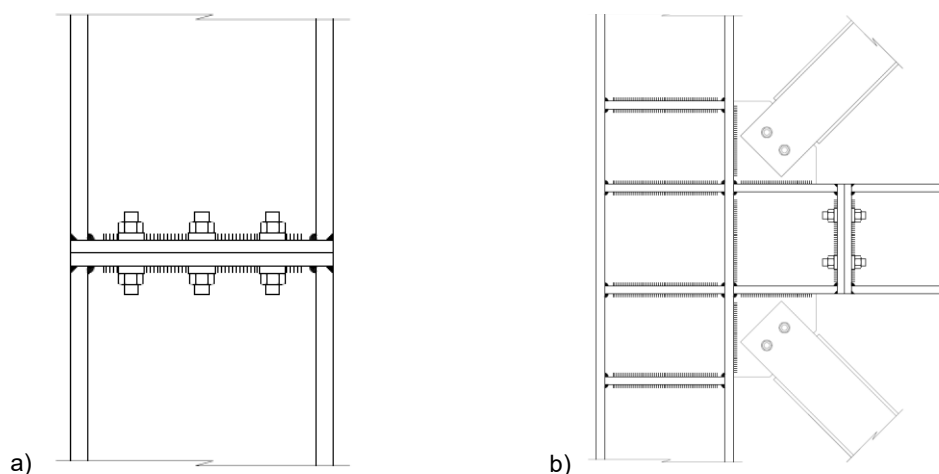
a) Unión entre pilares (entre plantas). b) Detalle de unión de pilar con viga y diagonales.
